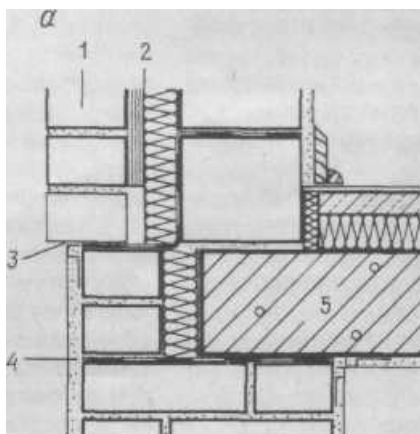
Двухслойная наружная стена из кирпича с теплоизоляцией. Толщина воздушной прослойки 40 мм. Облицовочная стенка прикреплена к основной кладке анкерами
